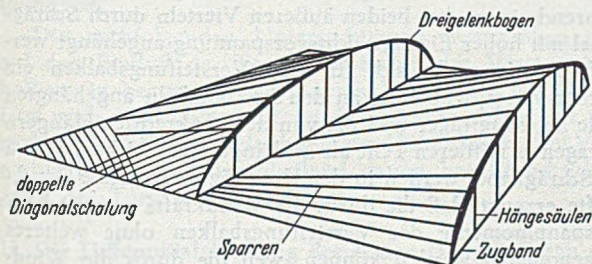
Schema der Tragkonstruktion des Daches der Halle VIII.
